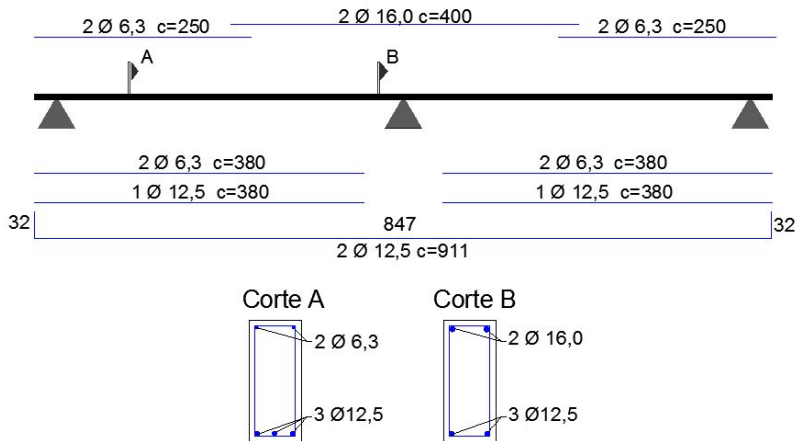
V1A-40: detalhamento da armadura longitudinal
